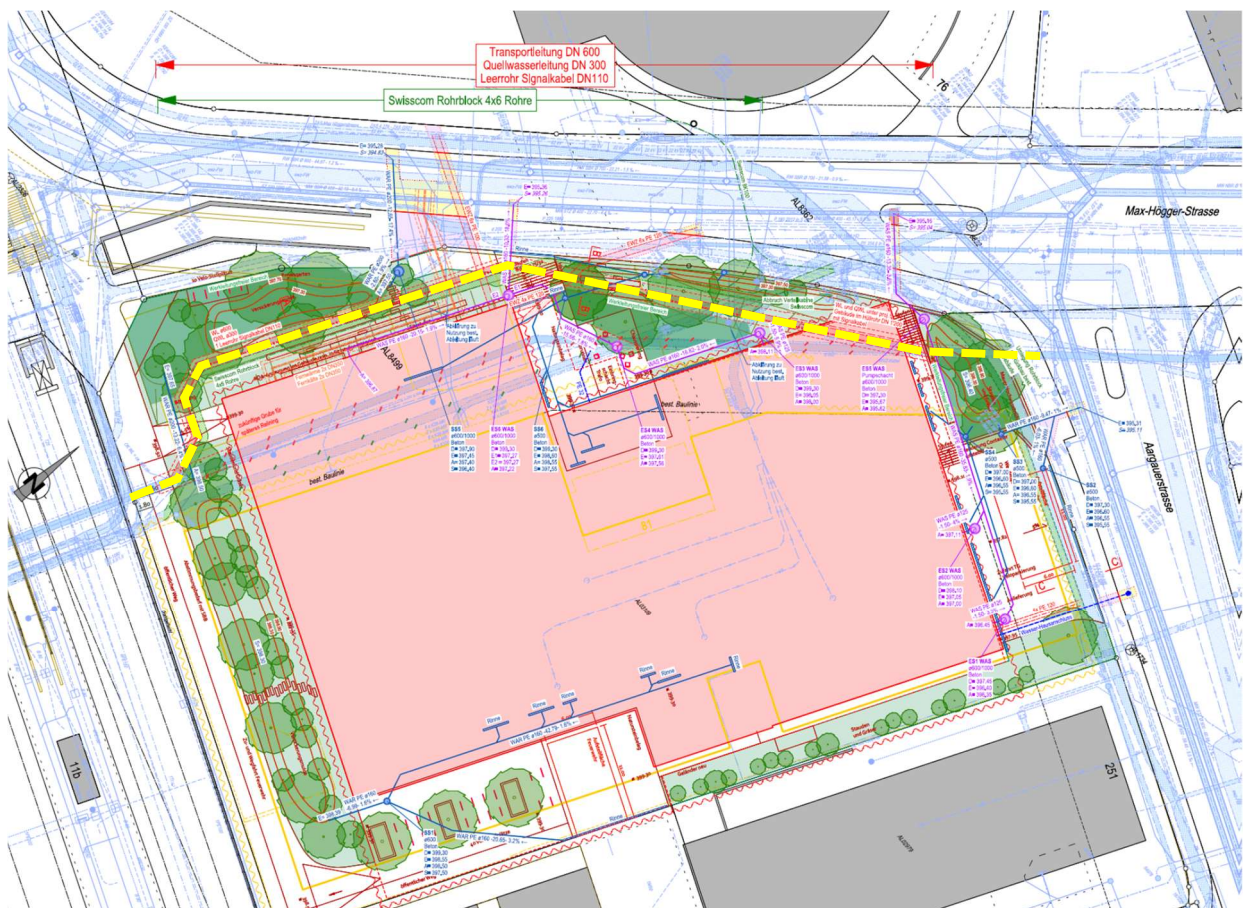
Ausschnitt Situation Liegenschaftsentwässerung, Werkleitungen, mit gelb hervorgehobener zukünftiger Lage der Wasserleitungen, Ingenieurbureau Heierli AG, 03.05.2023
